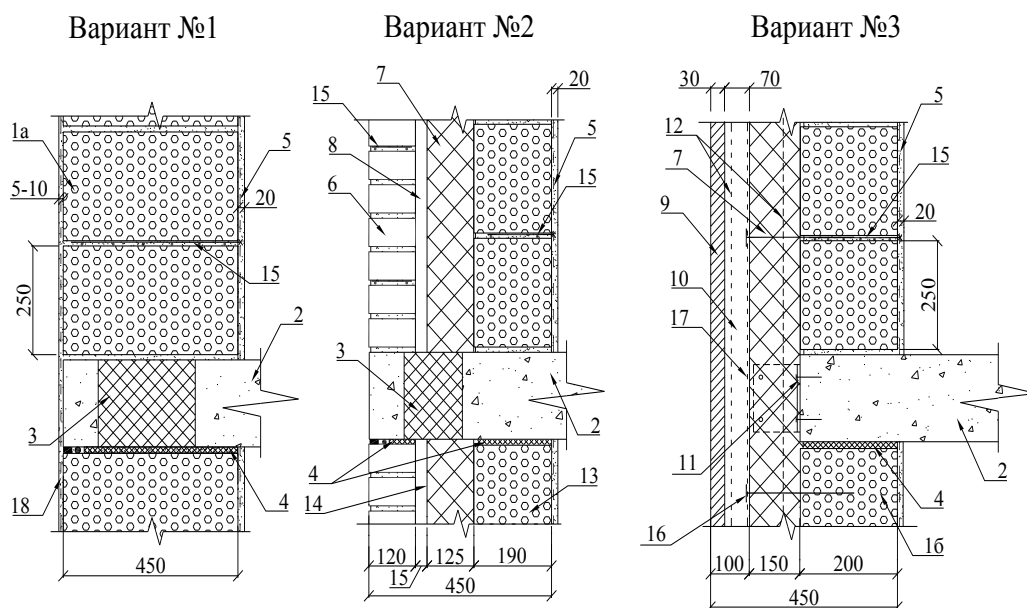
Варианты наружных стен: 1 – кладка из ячеистых блоков марки по плотности: а – D400, б – D600; 2 – плита перекрытия; 3 – термовкладыш; 4 – деформационный шов; 5 – штукатурка; 6 – кирпичная кладка; 7 – минераловатный утеплитель $\rho = 90 \text{ кг/м}^3$; 8 – неветилируемый воздушный зазор; 9 – облицовочные панели; 10 – вентилируемый воздушный зазор; 11 – кронштейн; 12 – «Г»-образная направляющая; 13 – кладка из керамзитобетонных блоков СКЦ; 14 – диффузионная пленка; 15 – оцинкованная сетка; 16 – базальтопластиковые связи; 17 – стеклопластиковая сетка; 18 – паропроницаемая штукатурка
